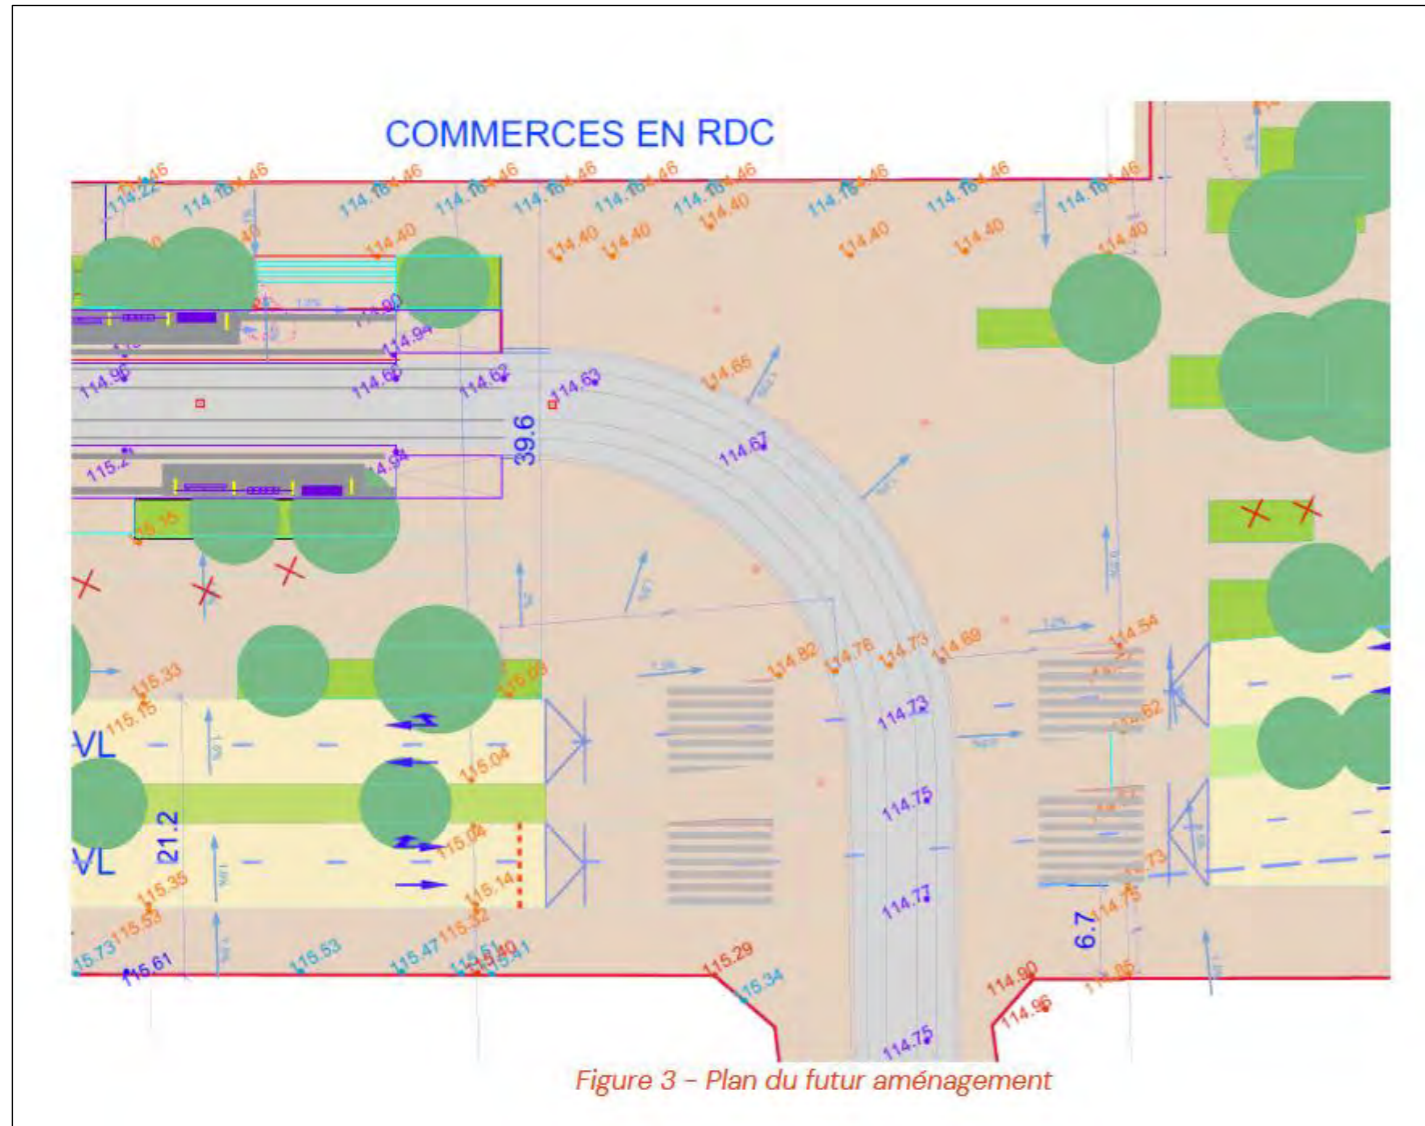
Plan du futur aménagement après démolition de la dalle piétonne
